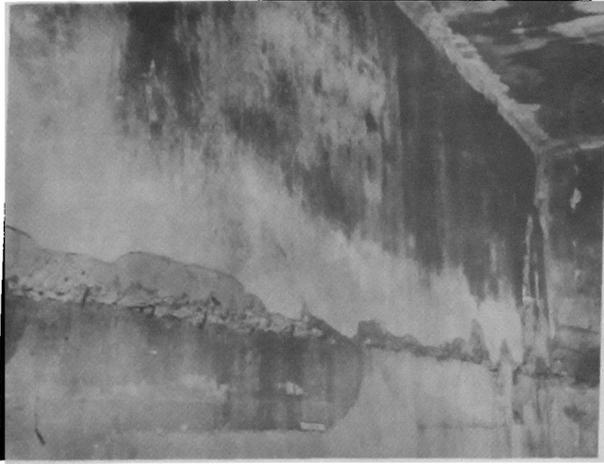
Junta de hormigonado en un muro. Corresponde al nivel superior de una losa que lo encuentra por detrás. Hospital Regional de Valdivia. 8º piso.
